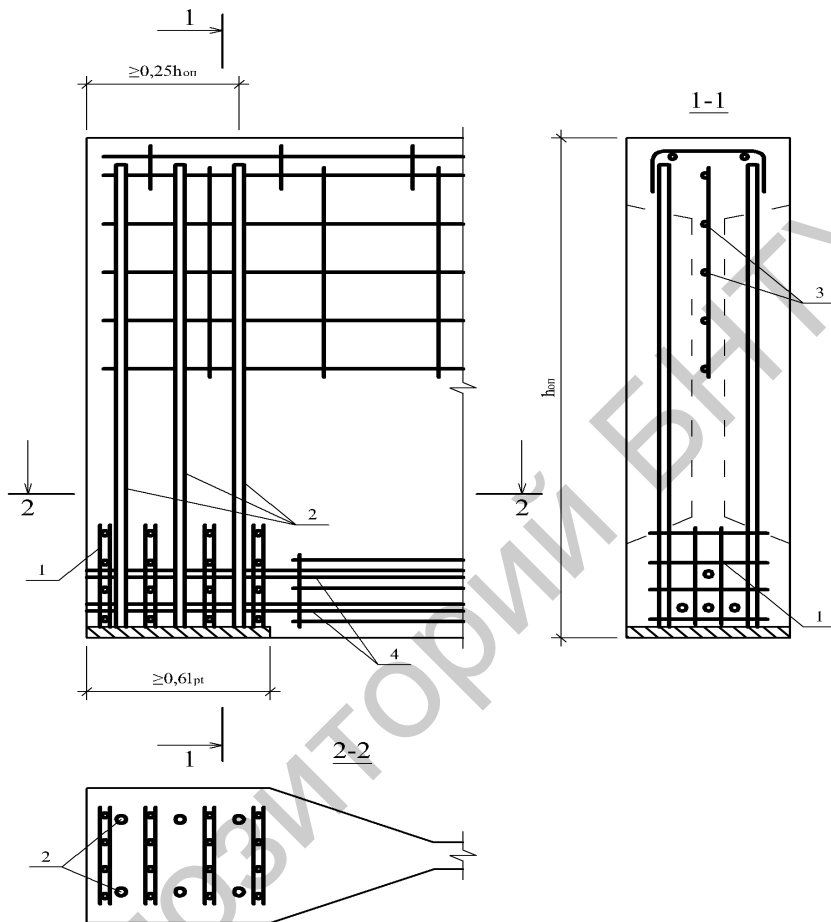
Армирование торца предварительно напряжённой балки (натяжение на упоры): 1 – сварные сетки в виде гребёнок (для удобства укладки напрягаемых стержней); 2 – поперечные стержни, привариваемые к закладным деталям; 3 – продольные стержни; 4 – напрягаемая арматура (основная поперечная арматура балок и арматура, устанавливаемая по контуру опорного уширения, не показана)
